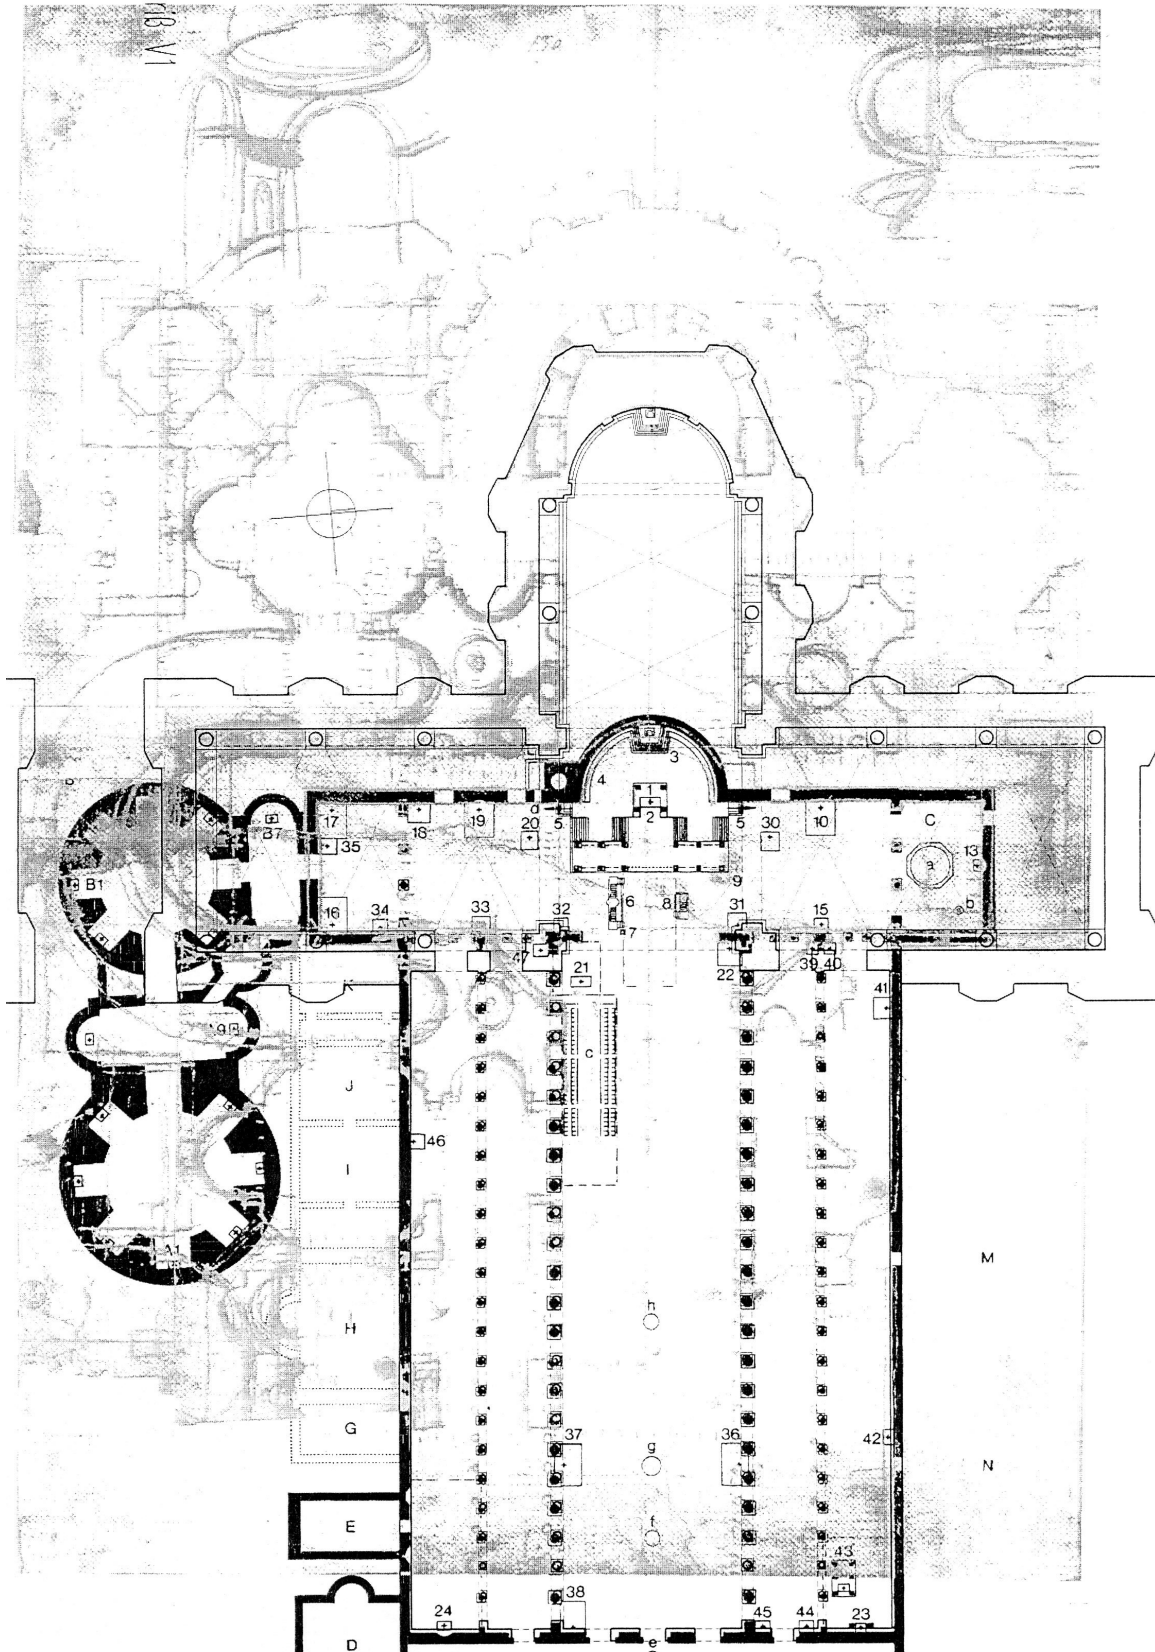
Rekonstruktion Grundriss Rosselinoprojekt mit eingebledetem Grundriss Alt-St. Peters nach DE BLAAUW, 1994.
